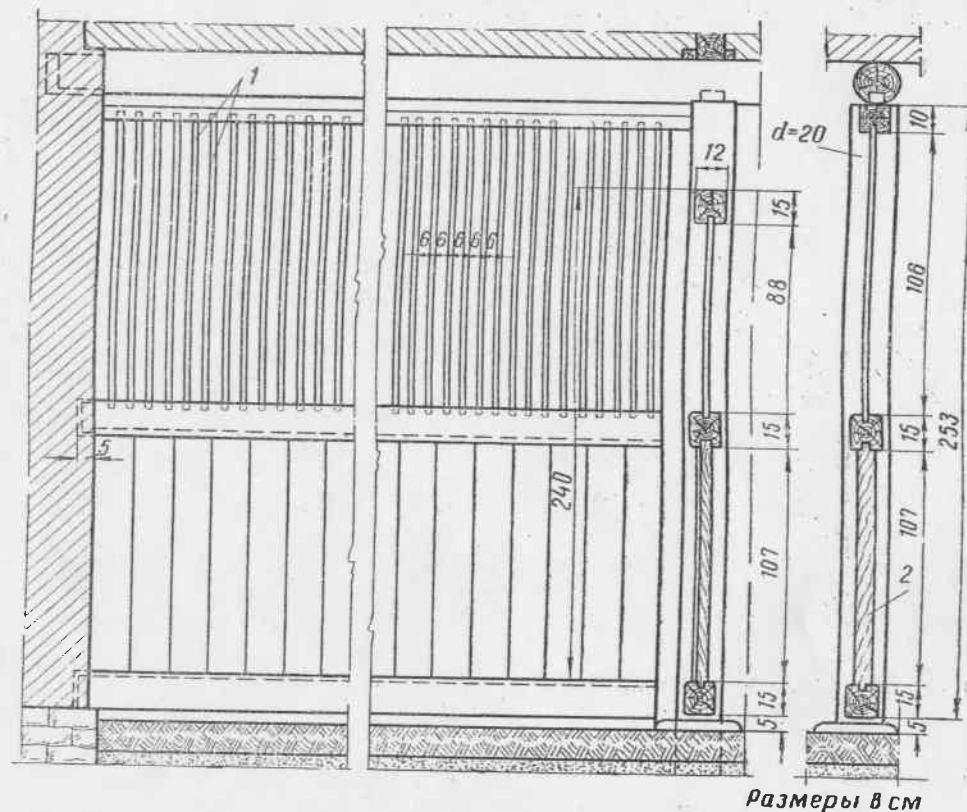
Перегородки между денниками в конюшнях для жеребцов (фасад и разрез): 1—решетка из стальных прутьев 2—перегородка из досок толщиной 5 см,
